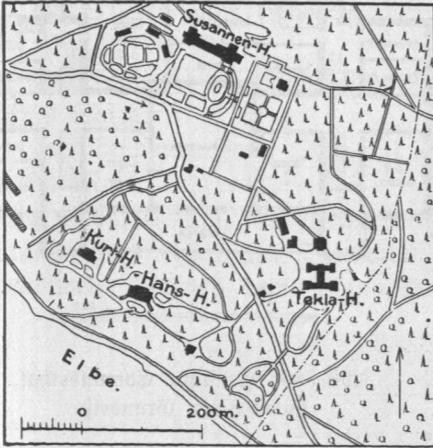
Heilstätte Edmundsthal, Lageplan.
